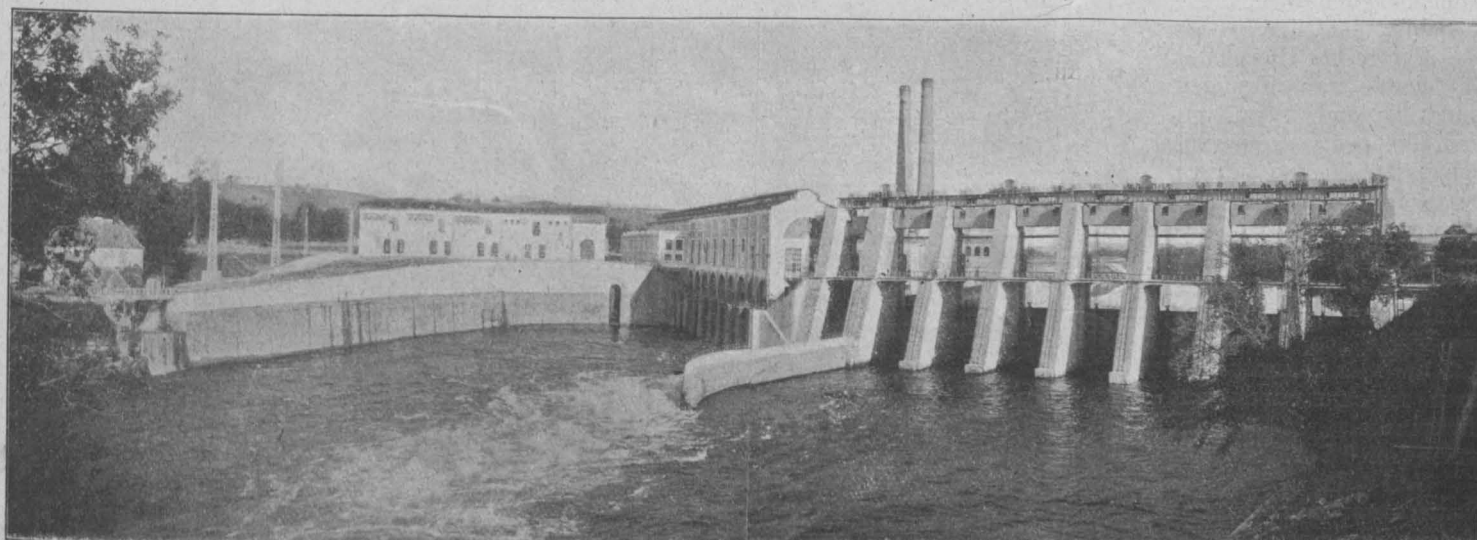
Tuilière, Gesamtansicht vom Unterwasser aus
